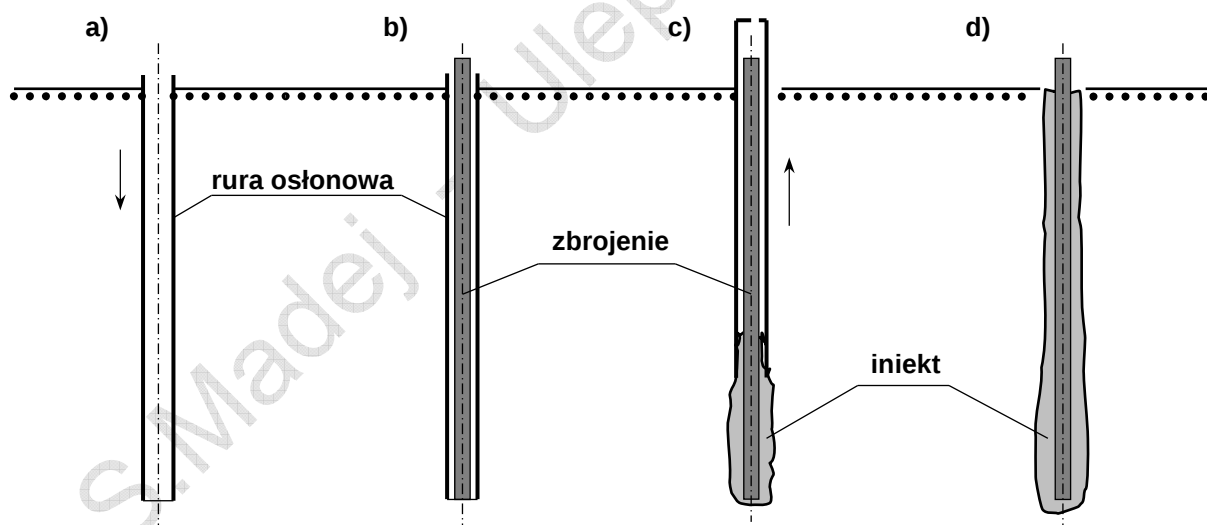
Przykłady zbrojenia gruntu mikropalami
